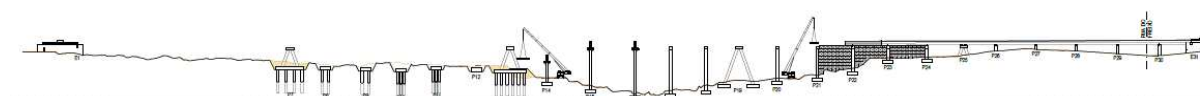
Faseamento construtivo – Etapa 2 de 5
